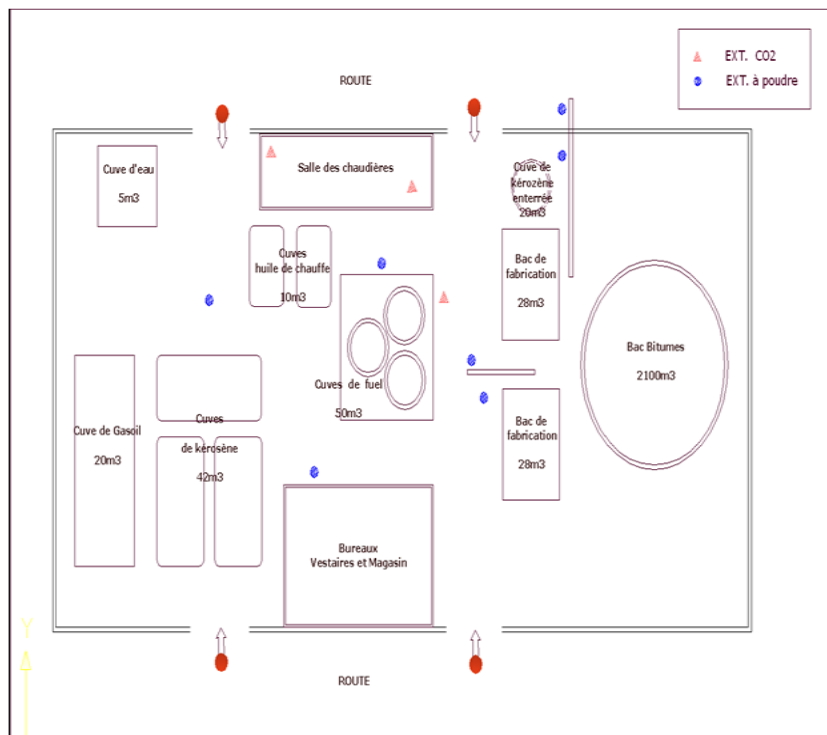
Plan de masse de l'unité B du Centre Bitume de Skikda [19]
